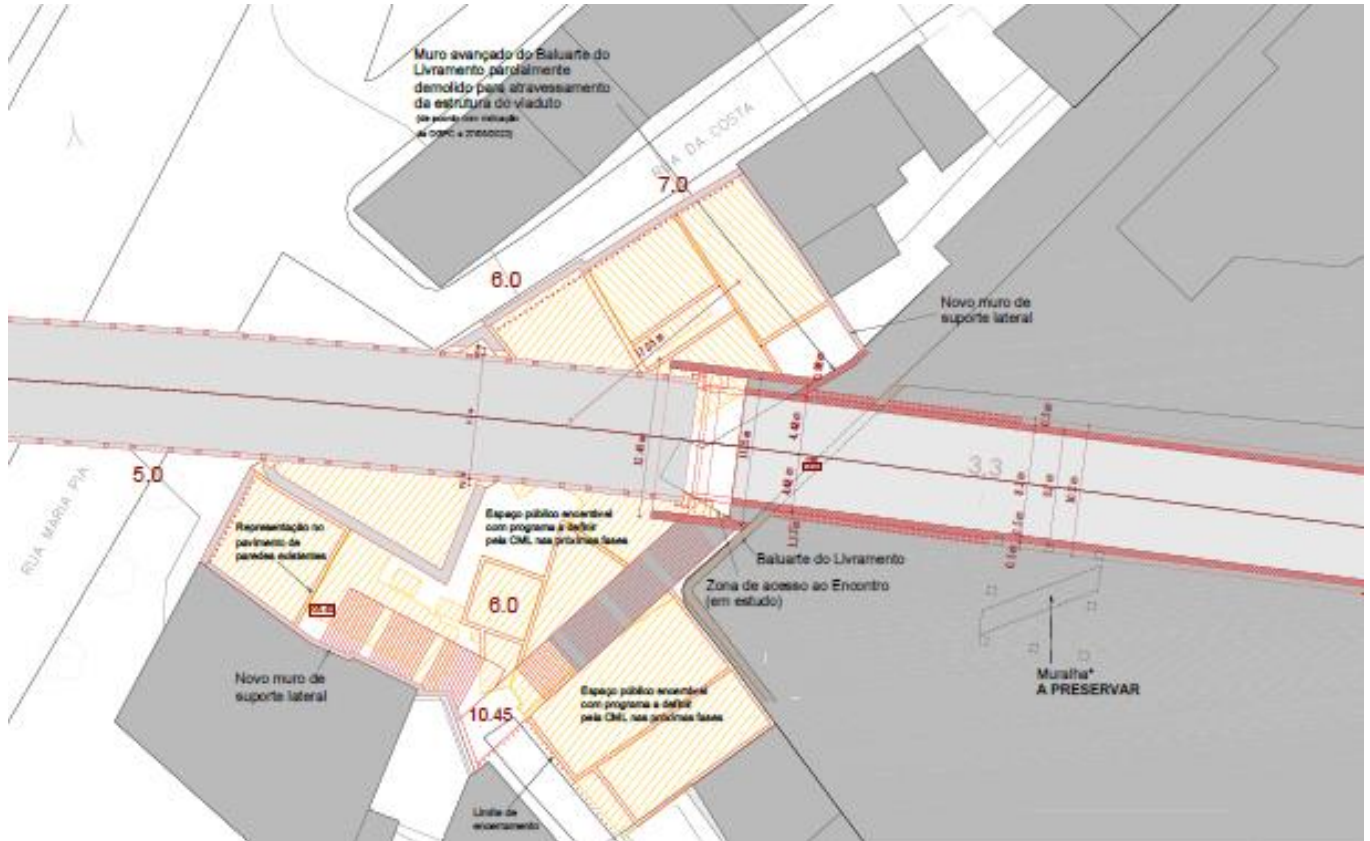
Planta - Transição Túnel/Viaduto no Baluarte do Livramento
